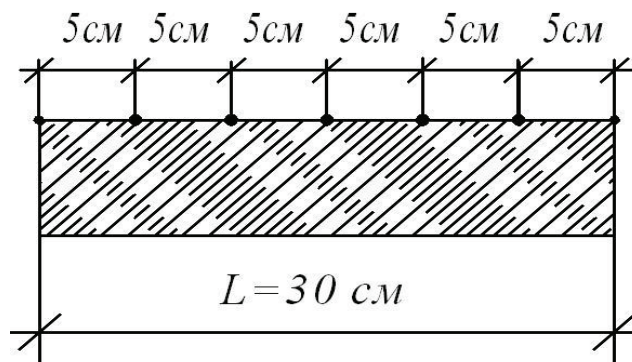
Схема розміщення точок вимірювання глибини колії
